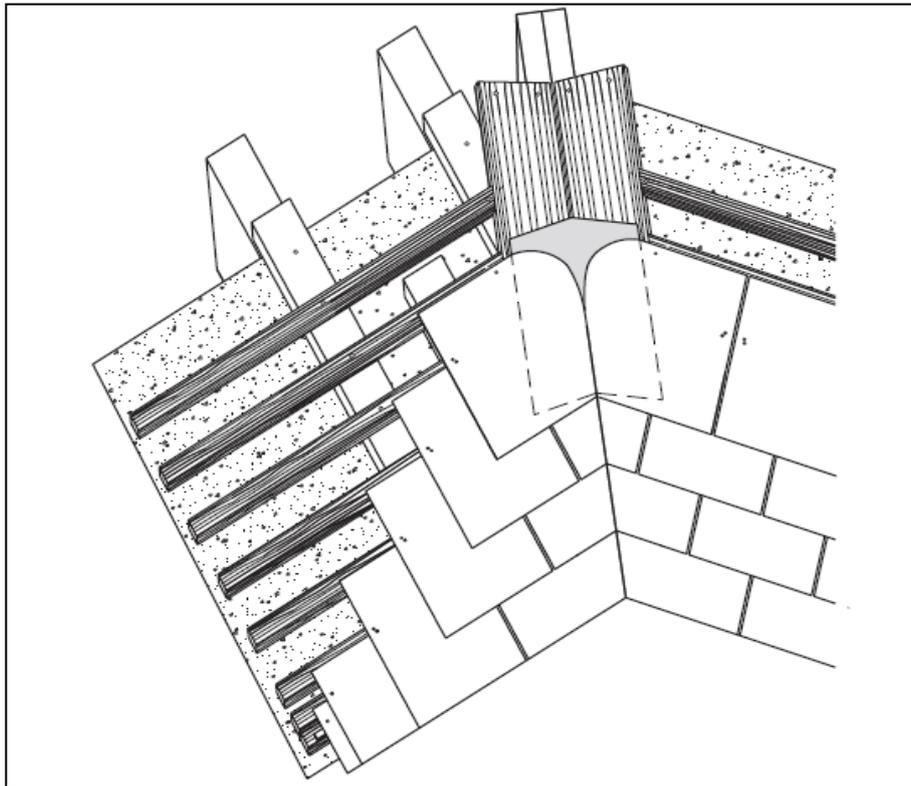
Blechnockenkehle mit Doppeldeckung auf Lattung
